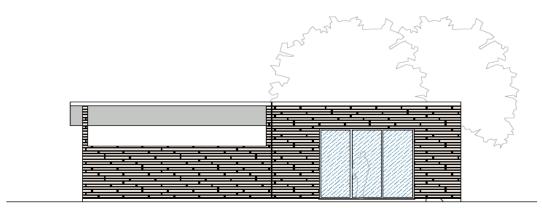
Stralcio tavola stato di progetto parcheggio Via Colombo
